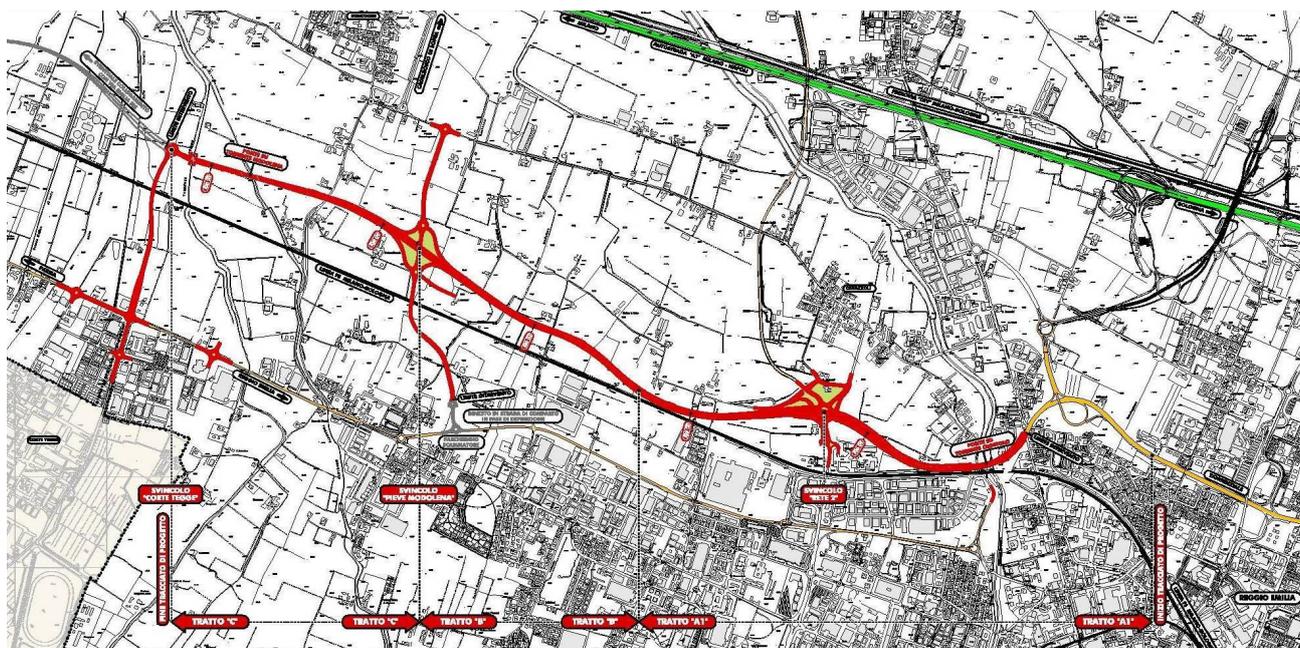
Configurazione funzionale del tracciato di progetto preliminare
